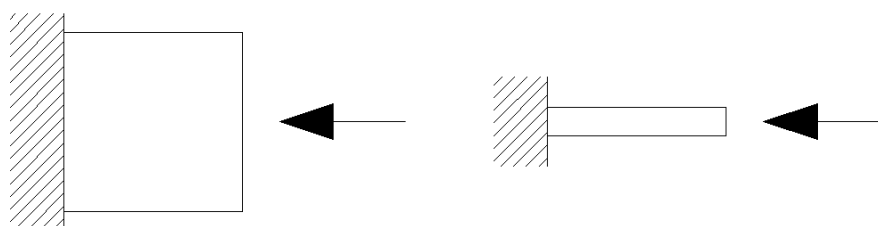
Esquema estrutural de dimensionamento da chapa de ligação
